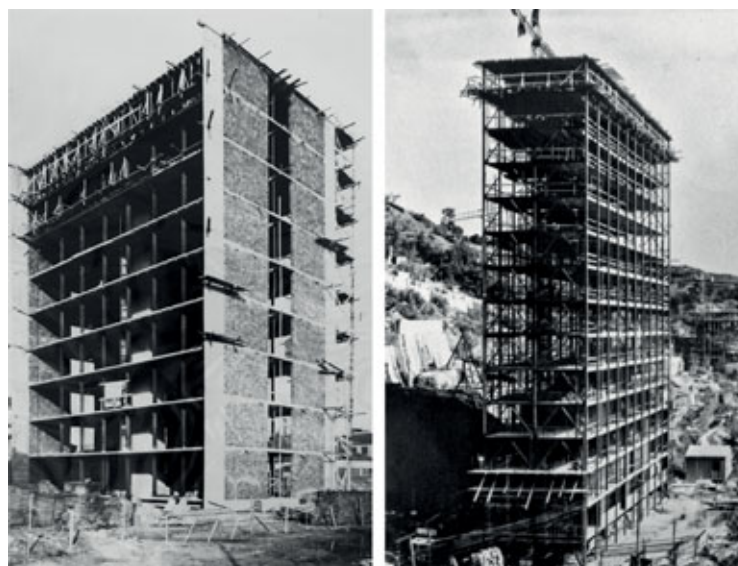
Prima fase operativa del Centro Carpenteria Dalmine (1952-1960): l'applicazione dei collegamenti proposti dall'ufficio tecnico diretto da Umberto Venanzi negli edifici residenziali a Como e a Genova Prà (Fondazione Dalmine).
